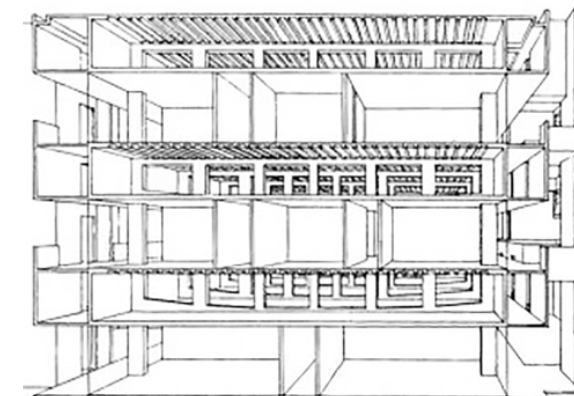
Estructura realizada con Vigas Vierendeel. Salk Institute, Arq. Louis Kahn, 1965.
